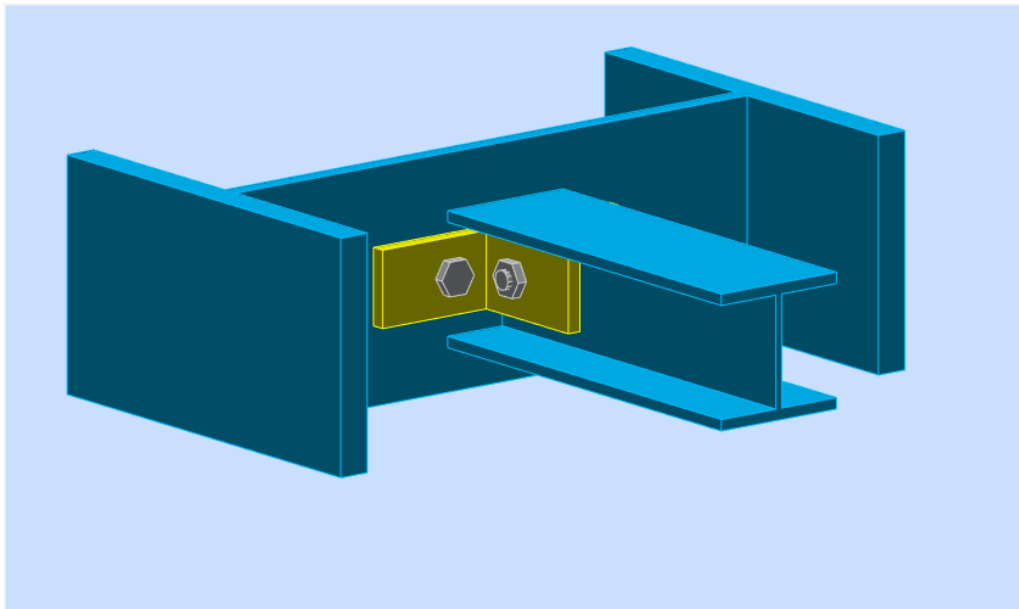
Assemblage poteau-sablière (HEA500–HEA100)
